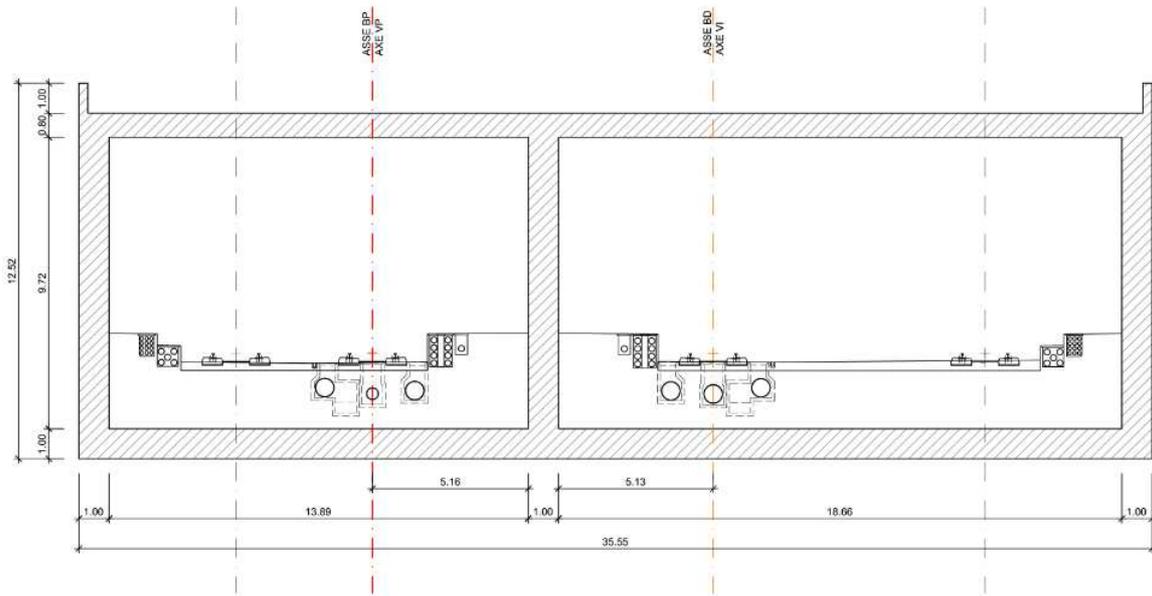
Sezione tipo galleria artificiale BP pk 61+084 – 61+116.52
